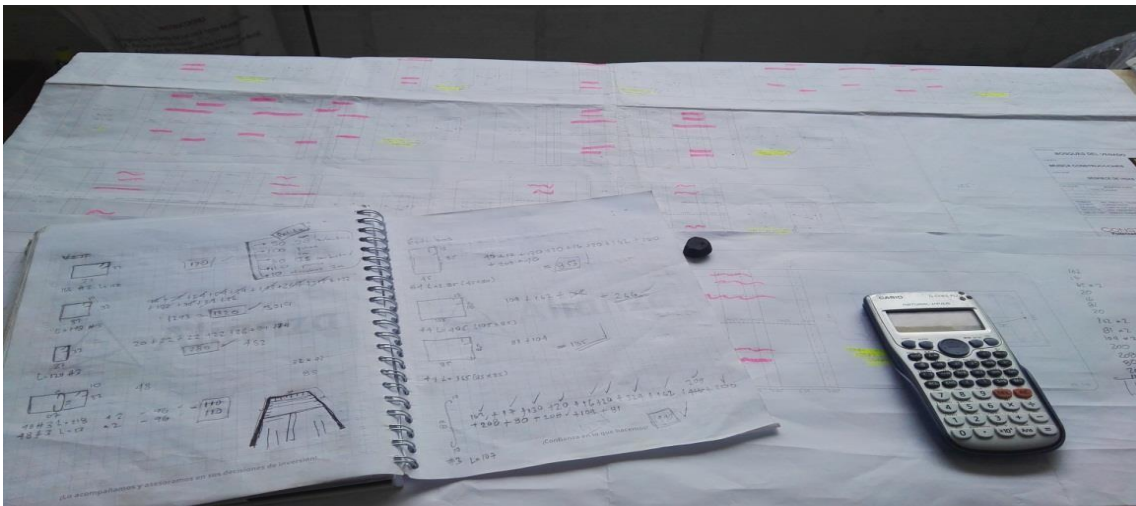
Calculo de cantidad de acero de vigas, pantallas y columnas para pedidos de material según los planos de despieces del diseñador
